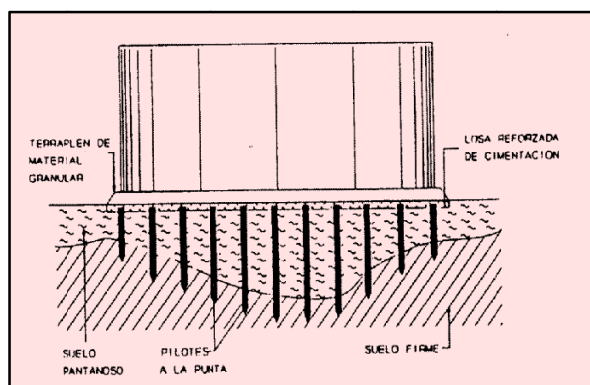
Cimentación rígida sobre pilotes a la punta
